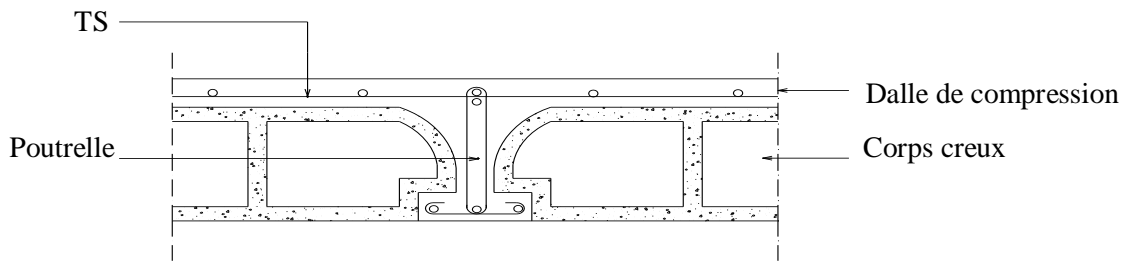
Coupe transversale d'un plancher à corps creux
